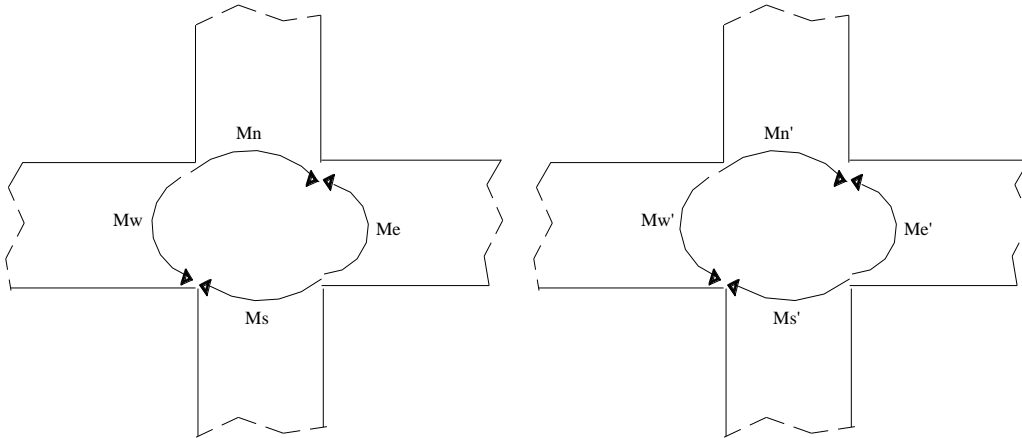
Dimensionnement des nœuds poteaux-poutres.
